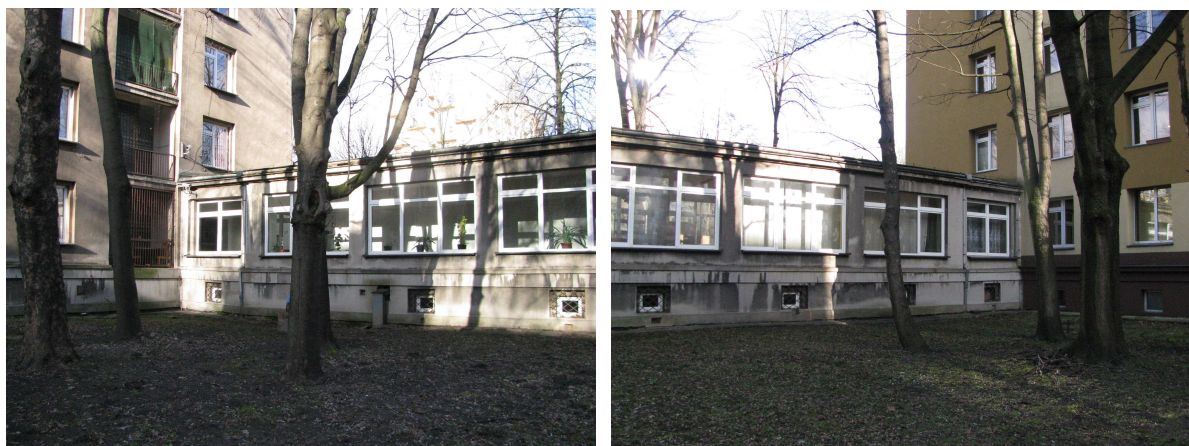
Elewacja zachodnia- wejście do restauracji dla klientów.
